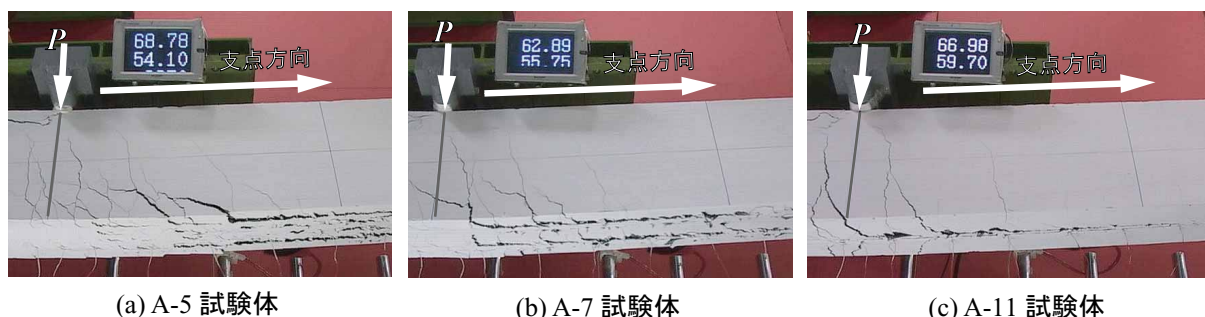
ロッド剥離時におけるひび割れ進展状況 (A 梁)
